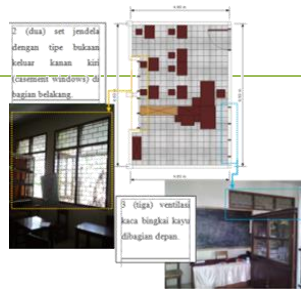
Potongan Ruang Kelas Persiapan Tunarungu
